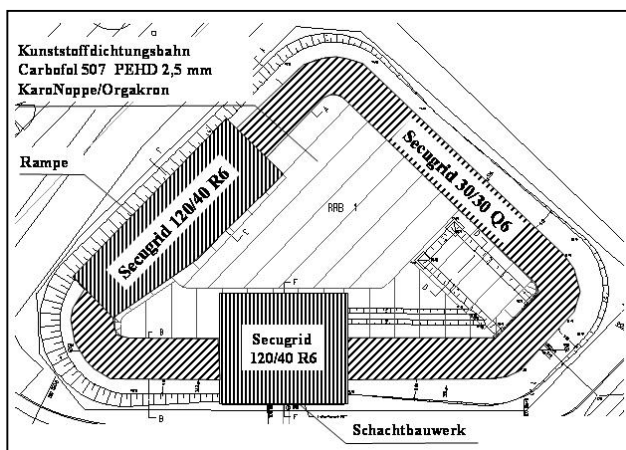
Verlegeplan der Bewehrungselemente für das Regenrückhaltebecken 1
